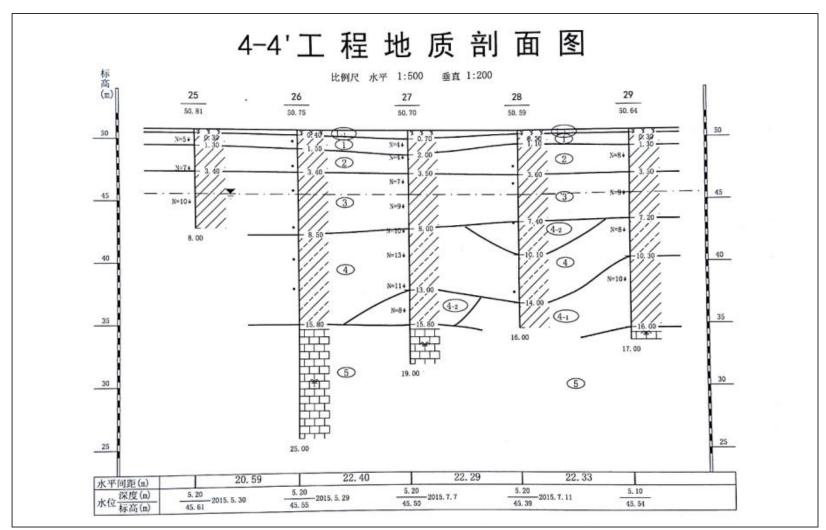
(2) 滕州亿达华闻煤电化有限公司工程地质剖面图
